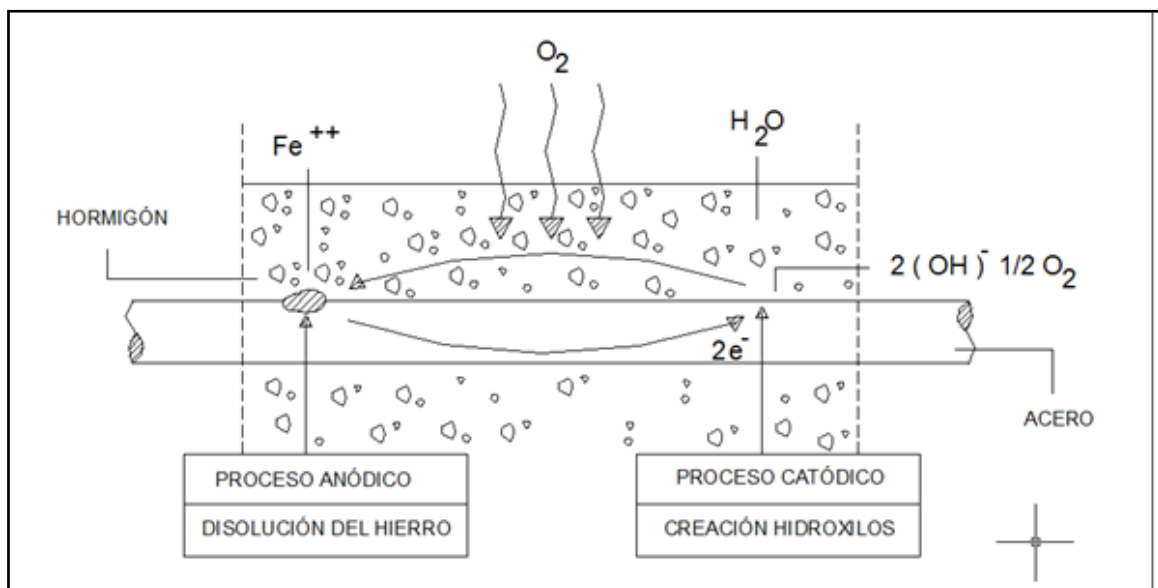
Esquema de la formación de una pila de corrosión en el hormigón armado.
